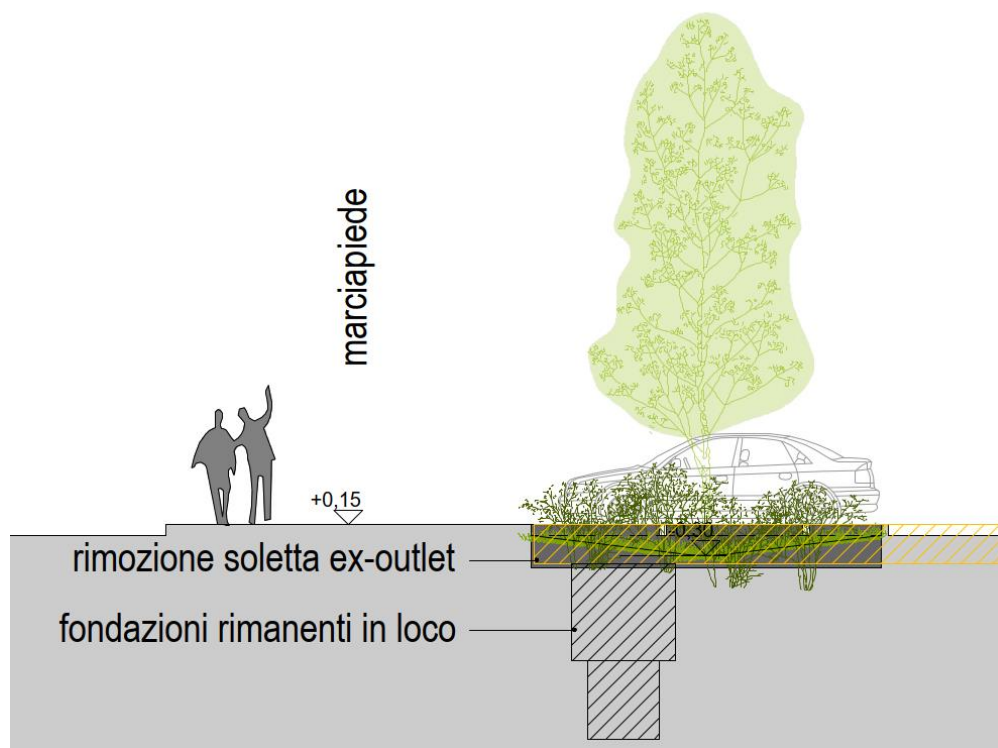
Prospetto di dettaglio aree de-sigillate - (Fonte: Tavola di progetto area ex Outlet)
